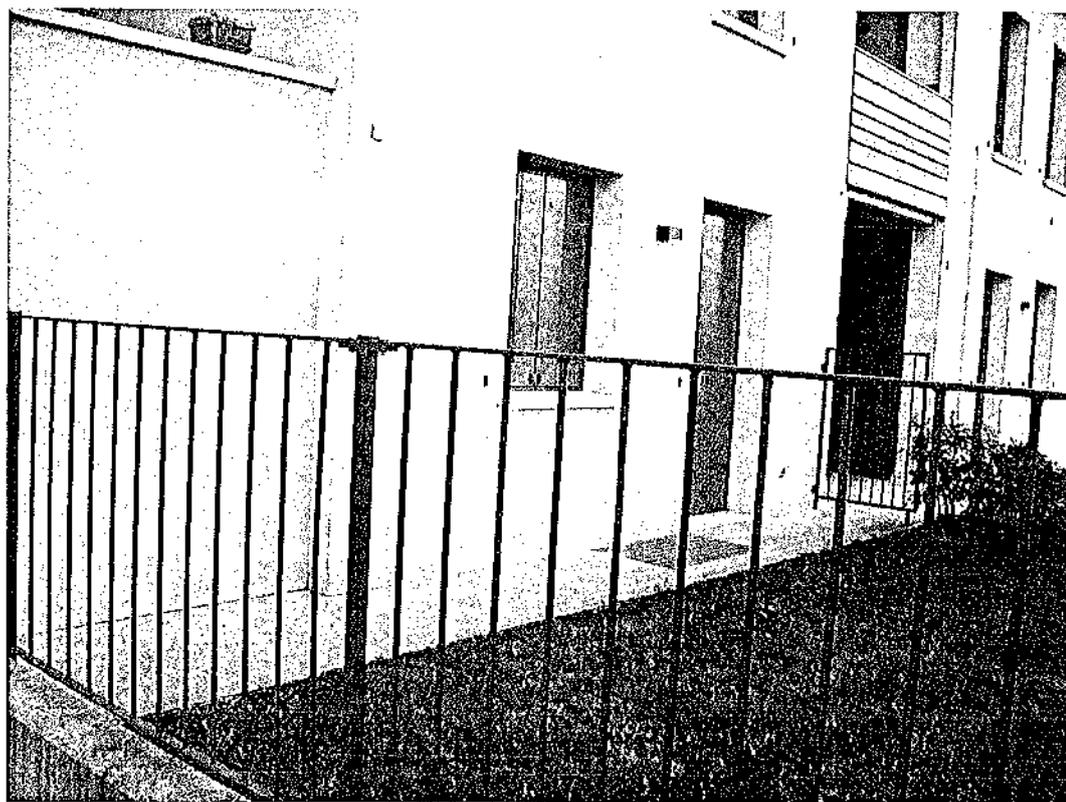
Appartamento n° 9 – Vista esterna del fronte Nord.
